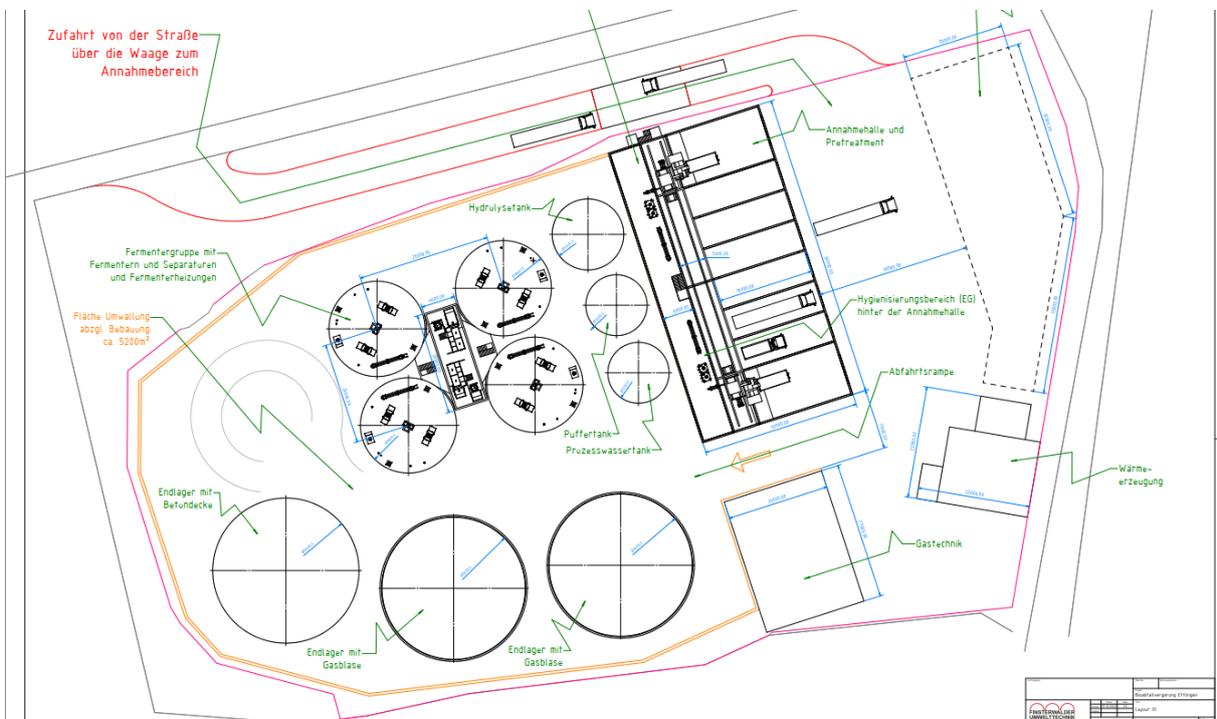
Lageplan der geplanten Bioabfallvergärungsanlage (Finsterwalder Umwelttechnik, Stand 19.10.2023)
